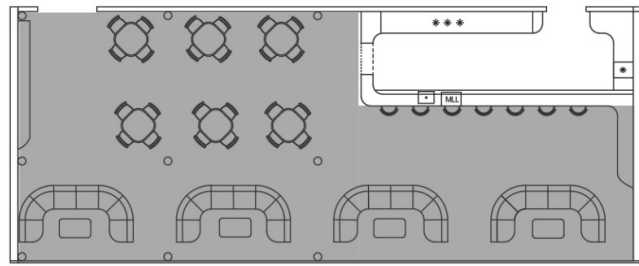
Identificação da Zona de Bar DECK em planta (Camila Schmidt,2025)
